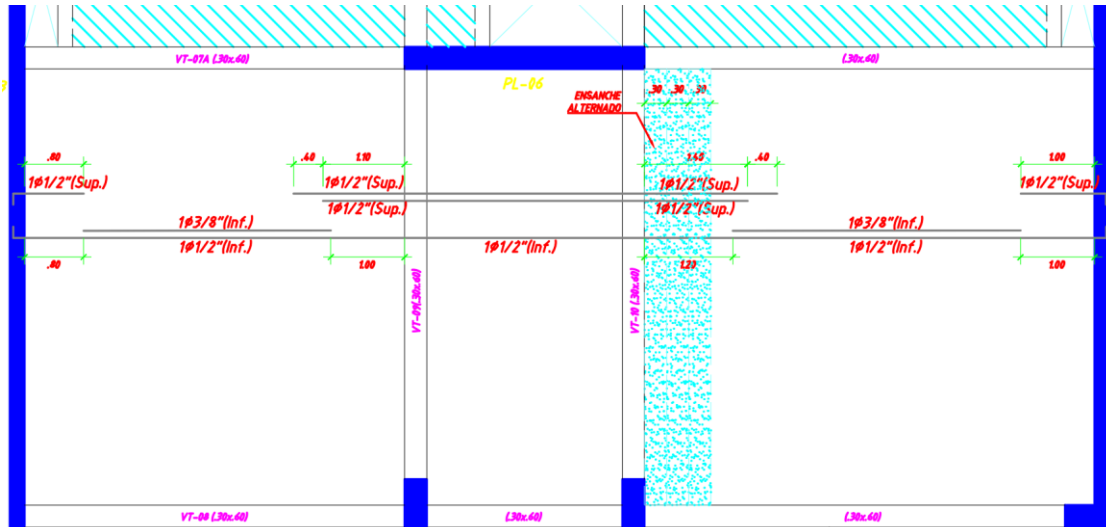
Diseño de losa aligerada en plano de encofrados.
